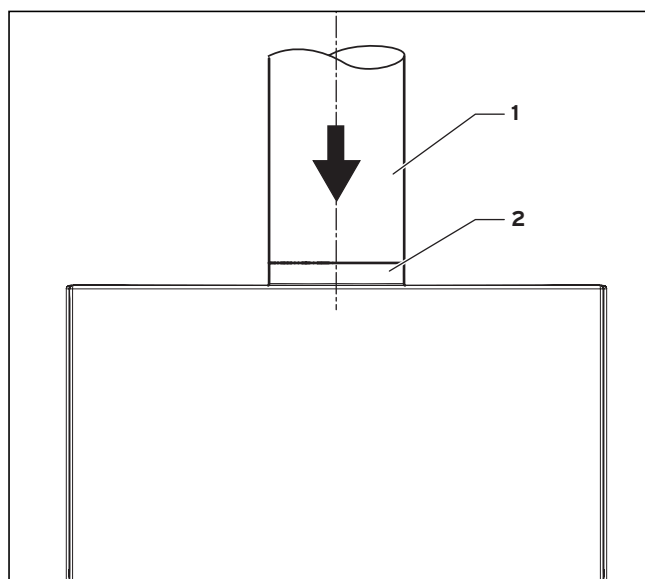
Przykład montażu: Pionowy przepust przez dach
